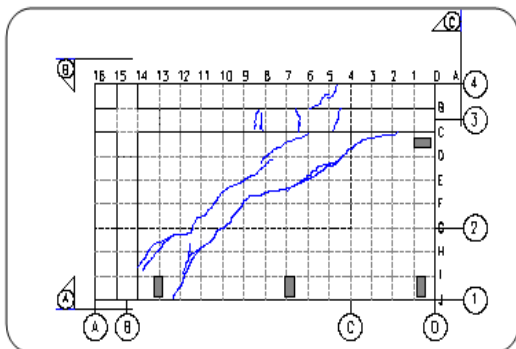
Tampak Bawah Pola Retak Pondasi Tipe 1C
